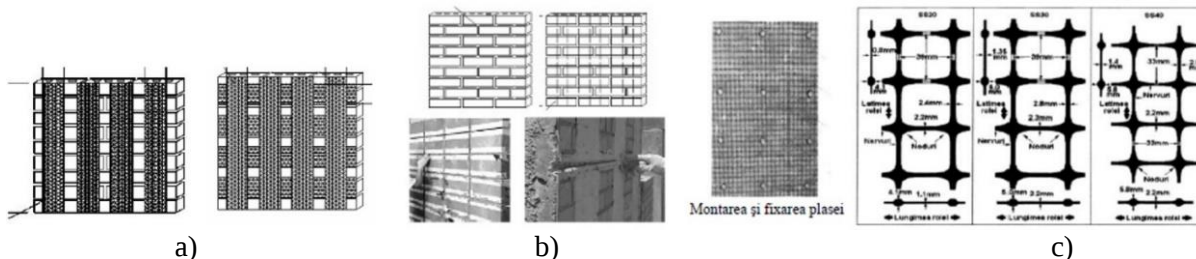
Detalii de placare a zidăriei cu tencuială/beton armat utilizate în România:
